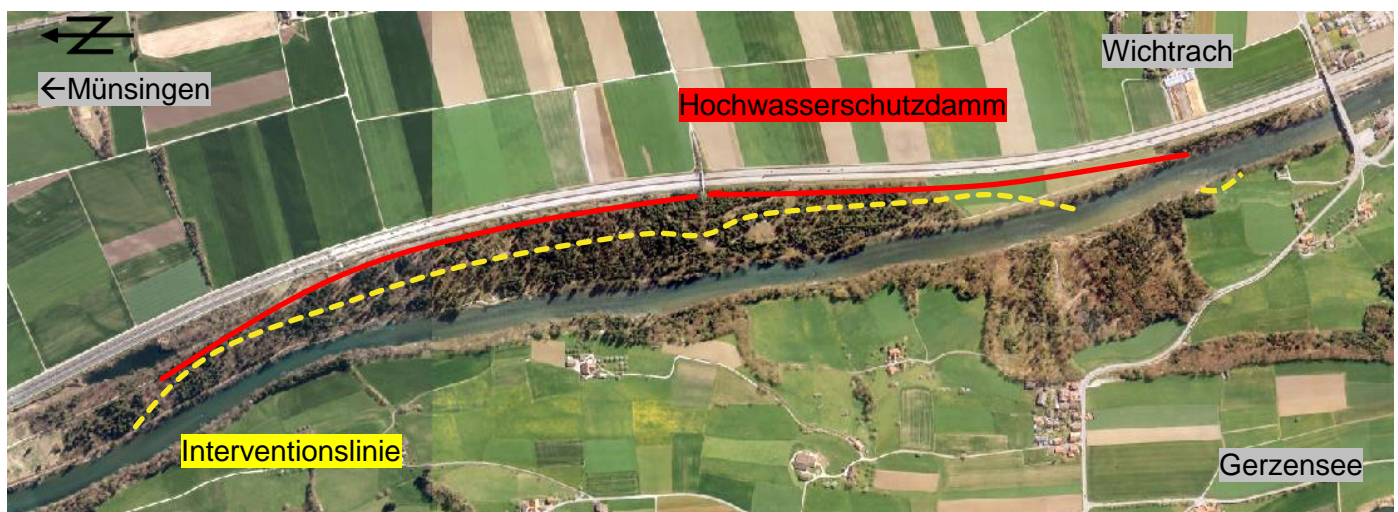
Gestaltungsperimeter mit geplanter Interventionslinie und Hochwasserschutzdamm.
